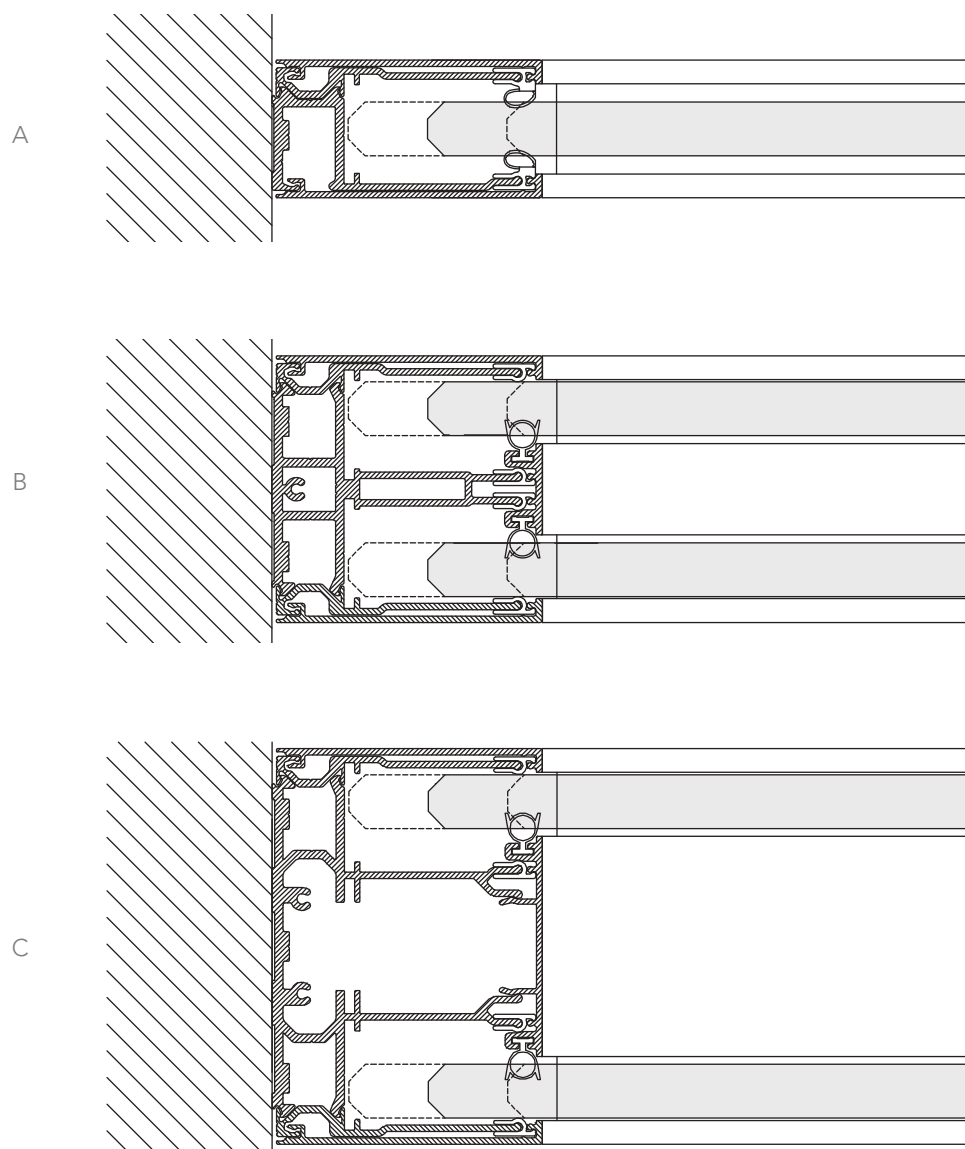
fig. A: Inizio/fine tratta telescopica - Parete Tipo 3
